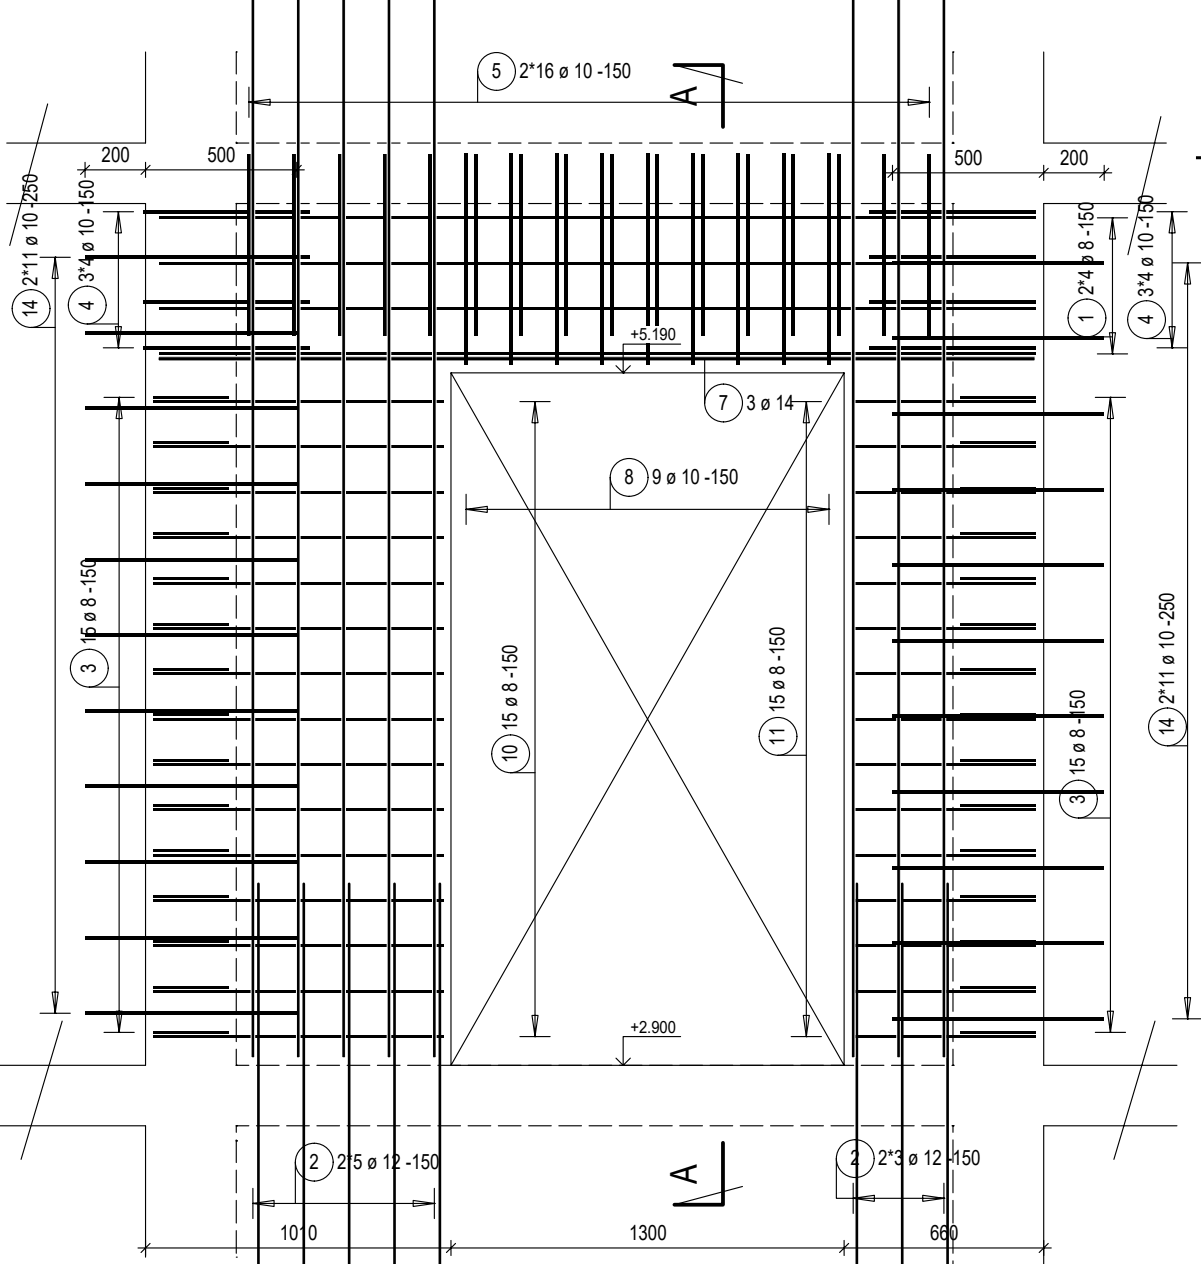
DETAIL PROKOTVENÍ STĚNY TL. 240 mm
